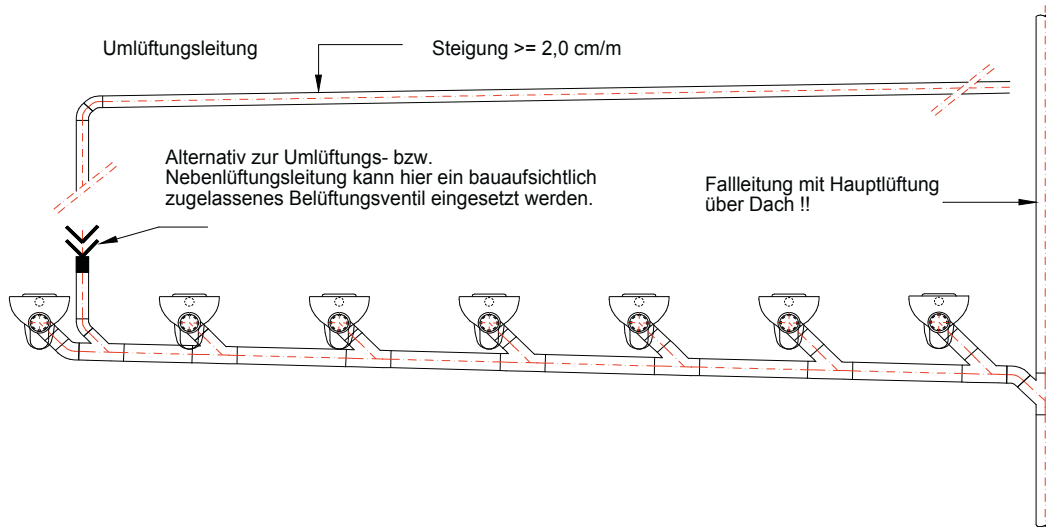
Ersatz einer Neben- bzw. Umlüftungsleitung durch Belüftungsventil bei einer hochbelasteten Sammelanschlussleitung
